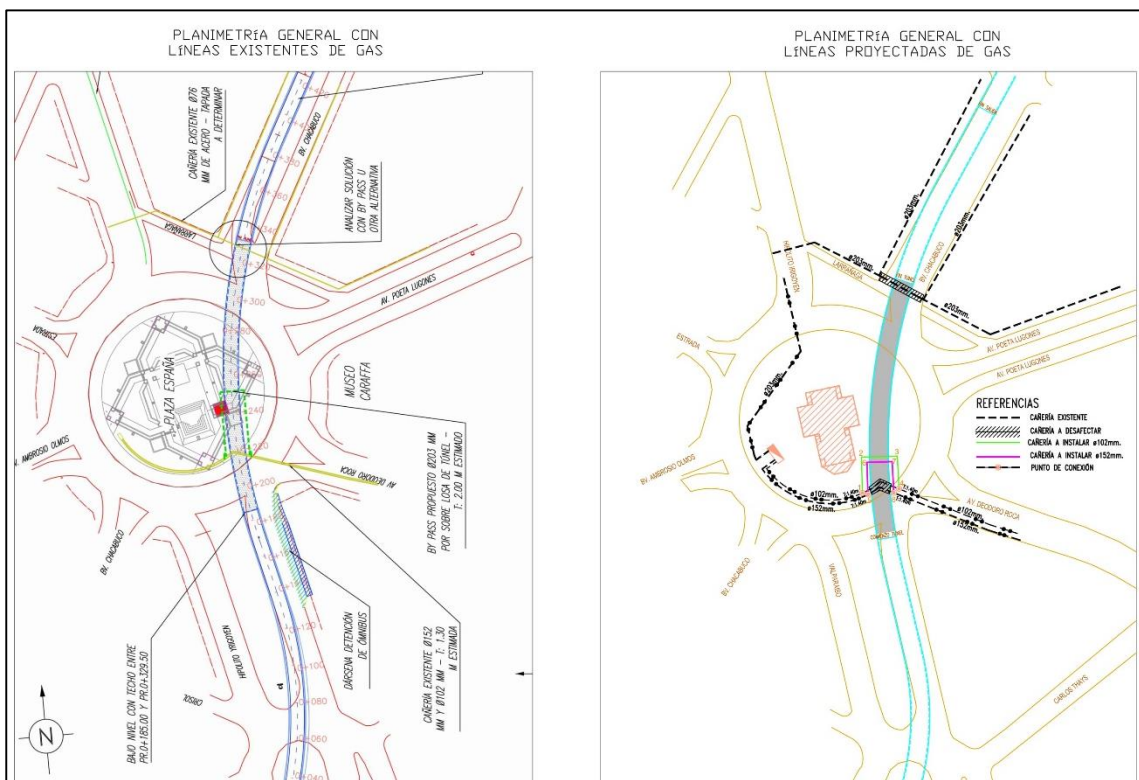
Planimetría general con líneas de gas existentes y proyectadas. (PLANO N°18)
